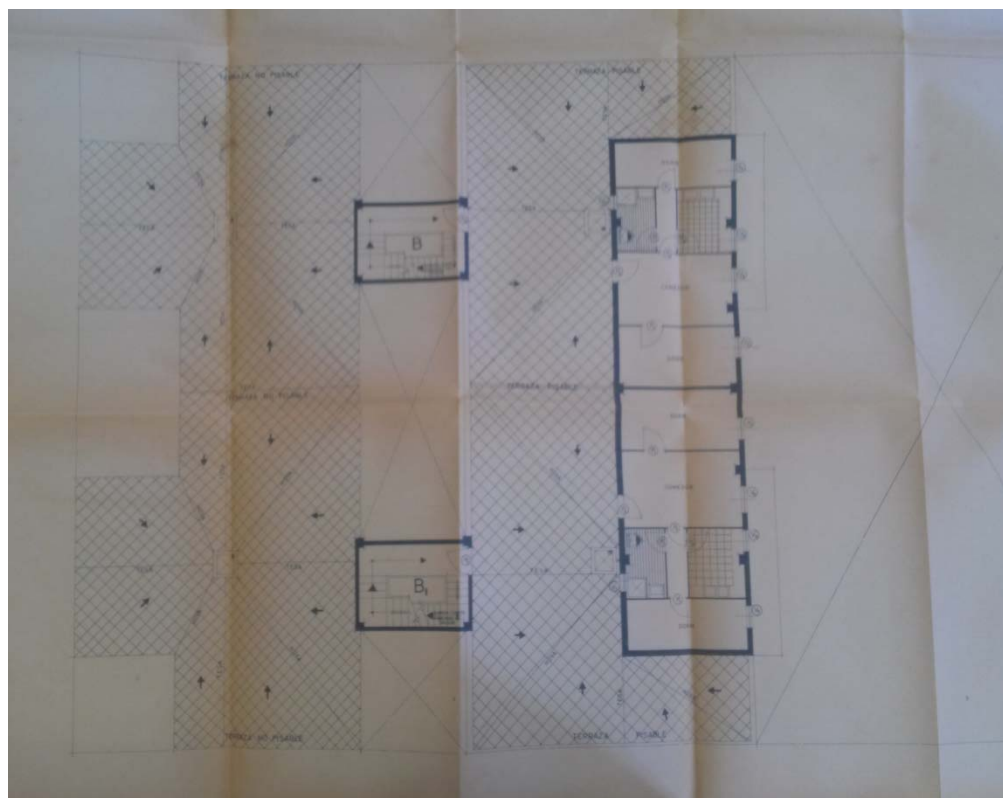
Plano planta terrazas y porterías zona interior.
